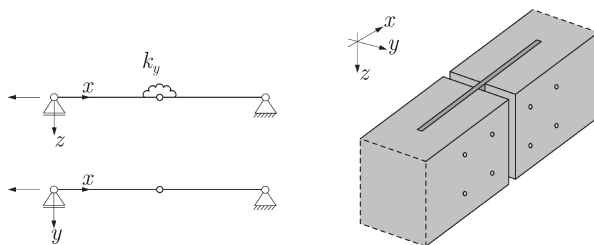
Zugstoß mit eingeschlitztem Stahlblech.
